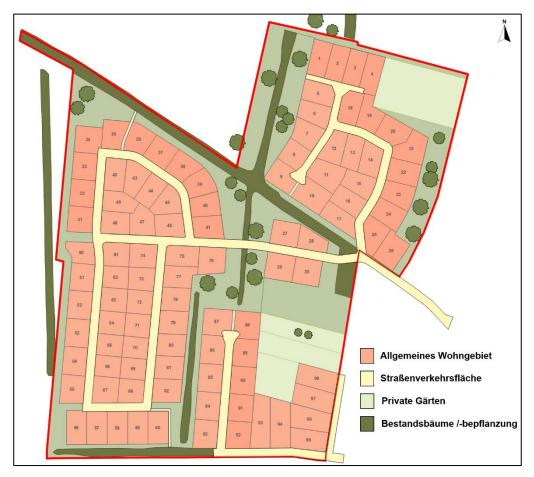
Skizzenhafte Darstellung des geplanten Bauvorhabens mit Parzellierung (Plangrundlage: PFE, Oktober 2023)
